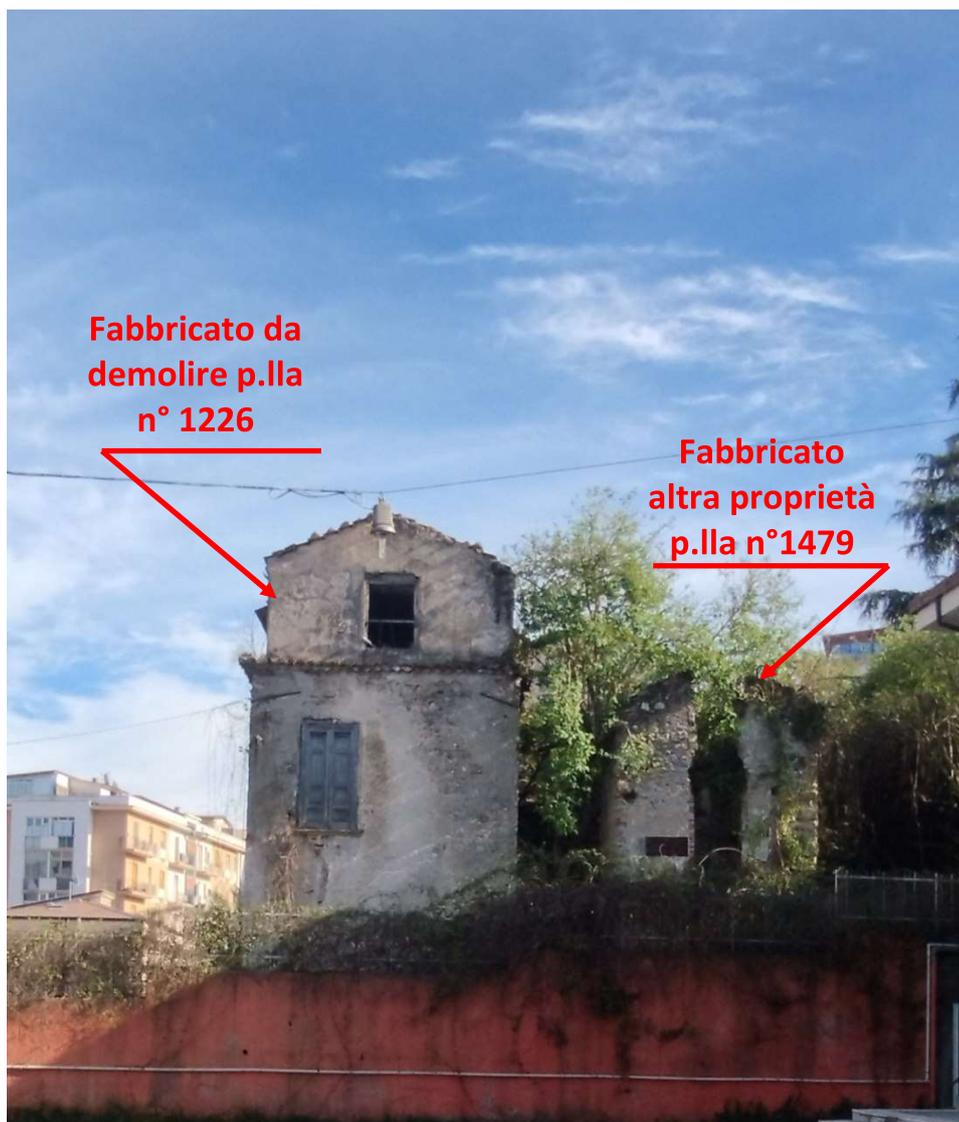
FABBRICATO DA DEMOLIRE, P.LLA N°1226, PROSPETTO NORD
